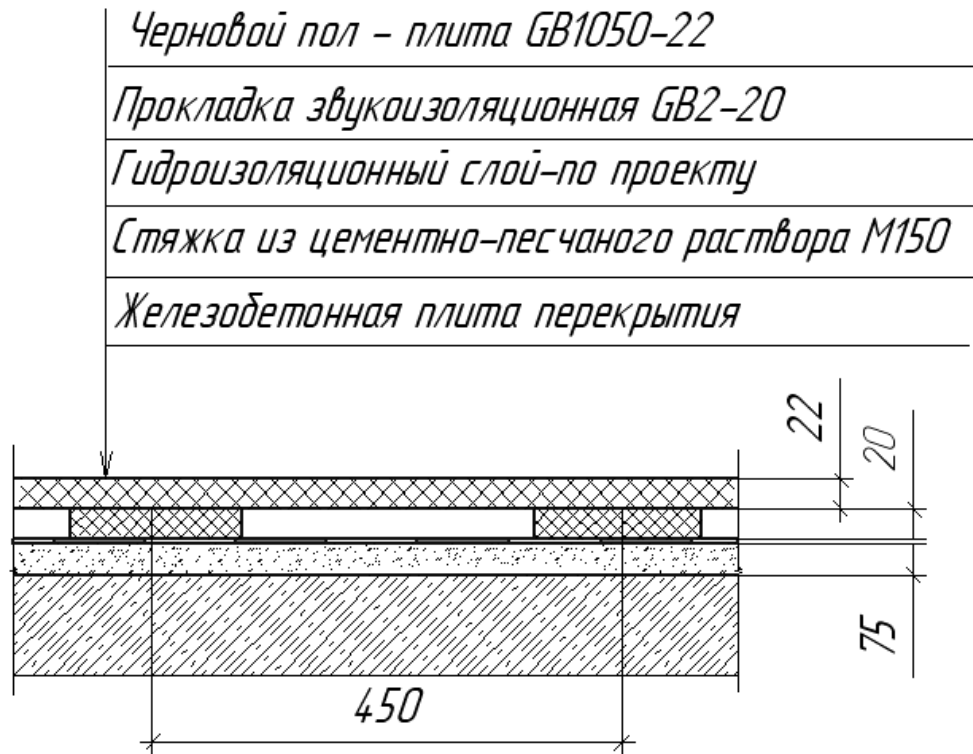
Конструкция «плавающего» пола по плите перекрытия
